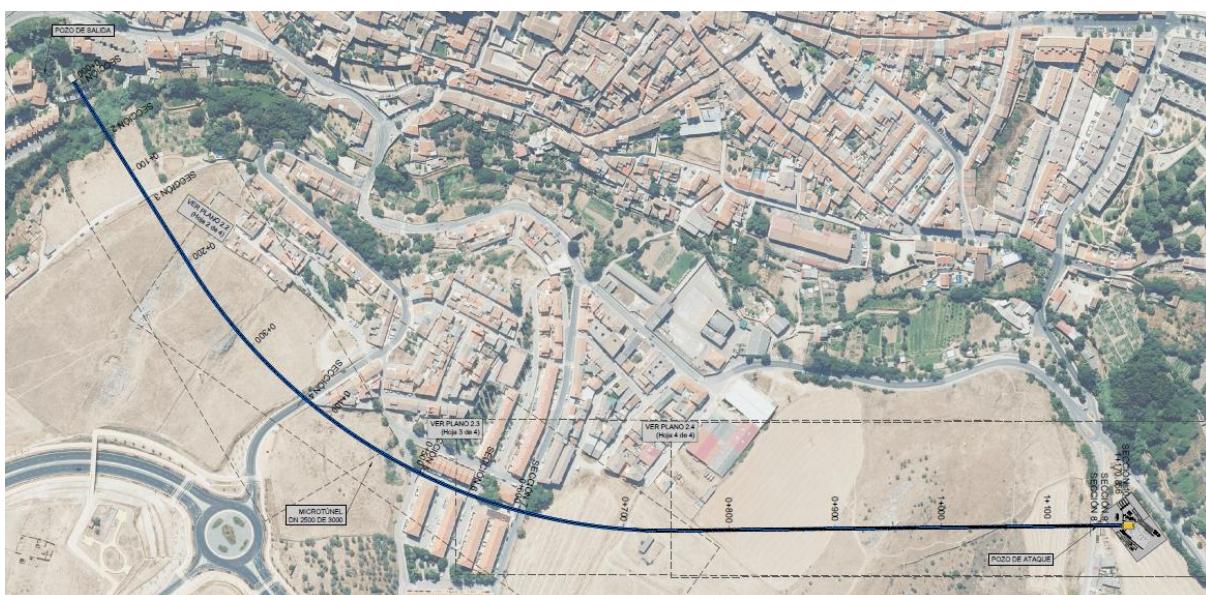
Planta general del trazado del túnel San Francisco-Puente Vadillo
